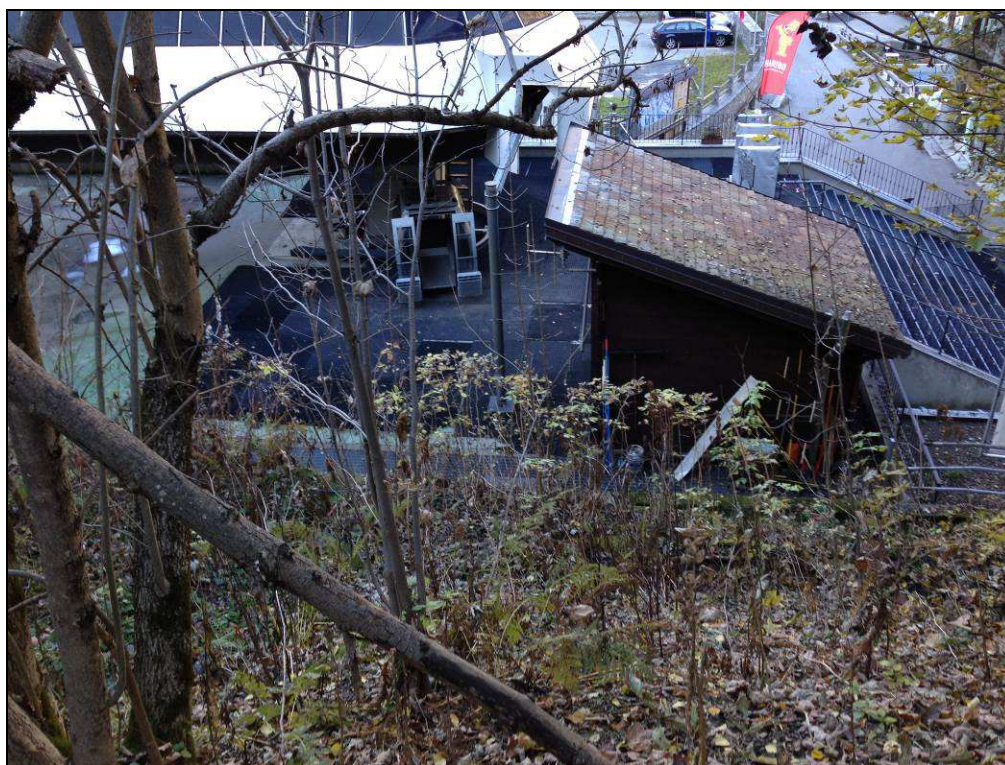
/2 – imbocco della variante con vista verso valle (sulla sx la frazione Dosso)
